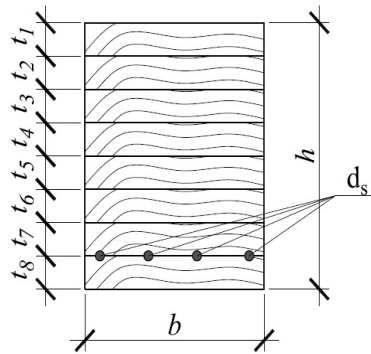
Геометрична схема поперечного перерізу балки з армуванням нижньої зони.
